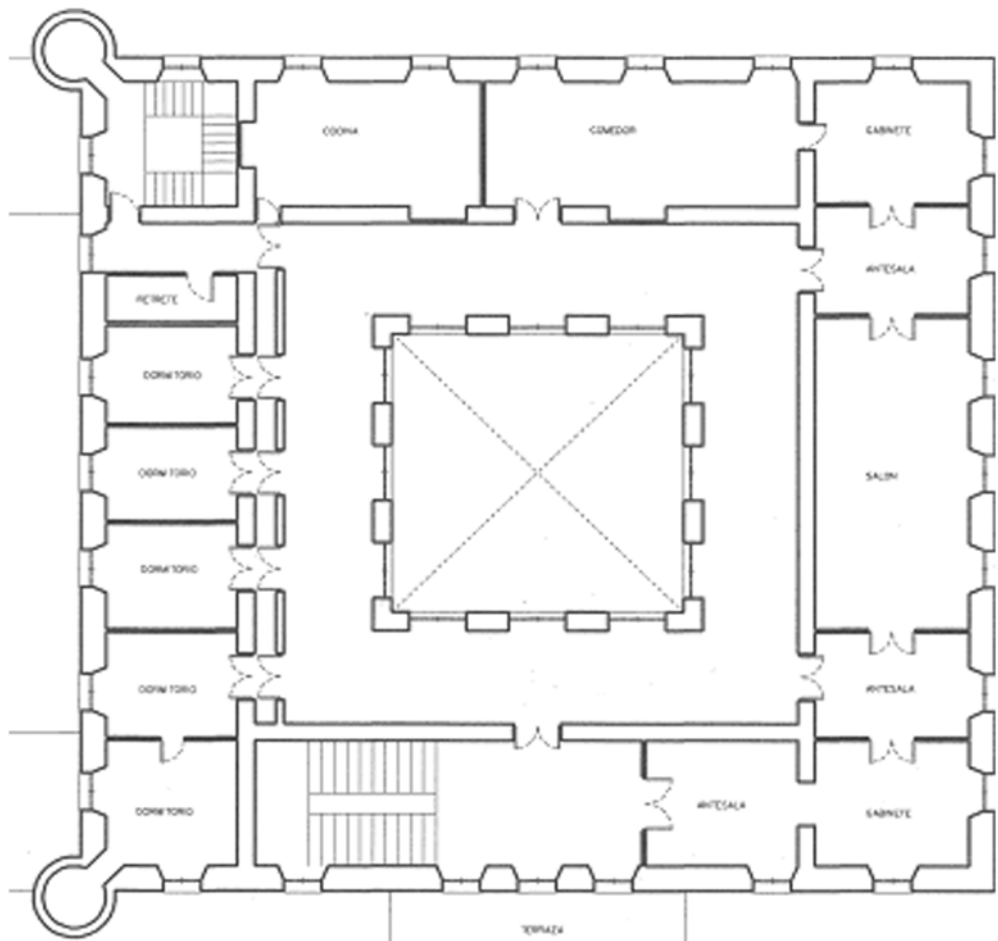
Plano de la planta primera (hipótesis del estado original).
